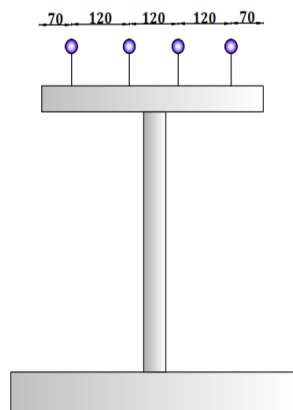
DISPOSITION TRANSVERSALES DES GOUJONS SUR LA POUTRE
